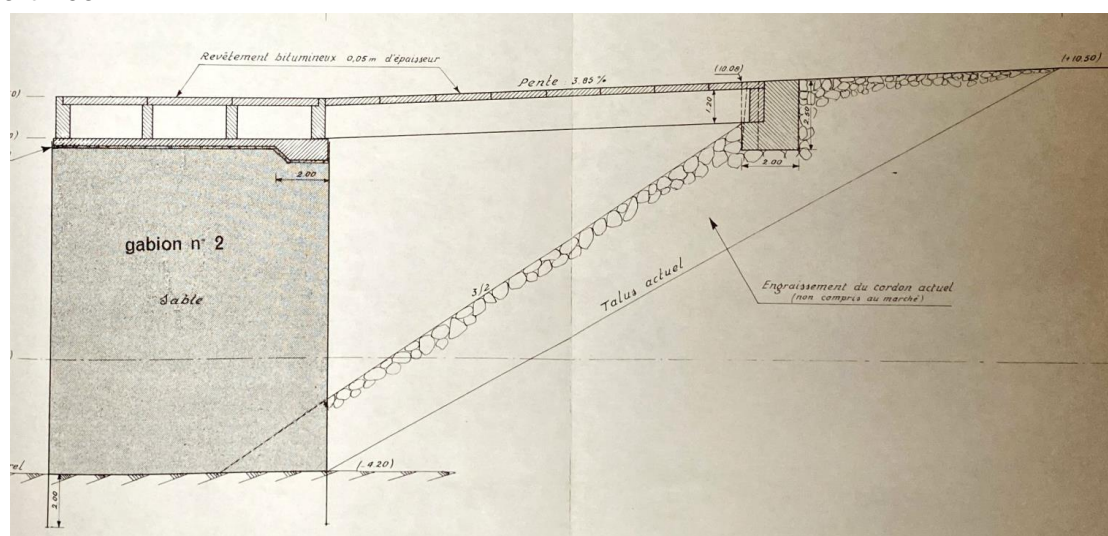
Extraits du plan d'archive de l'ouvrage
